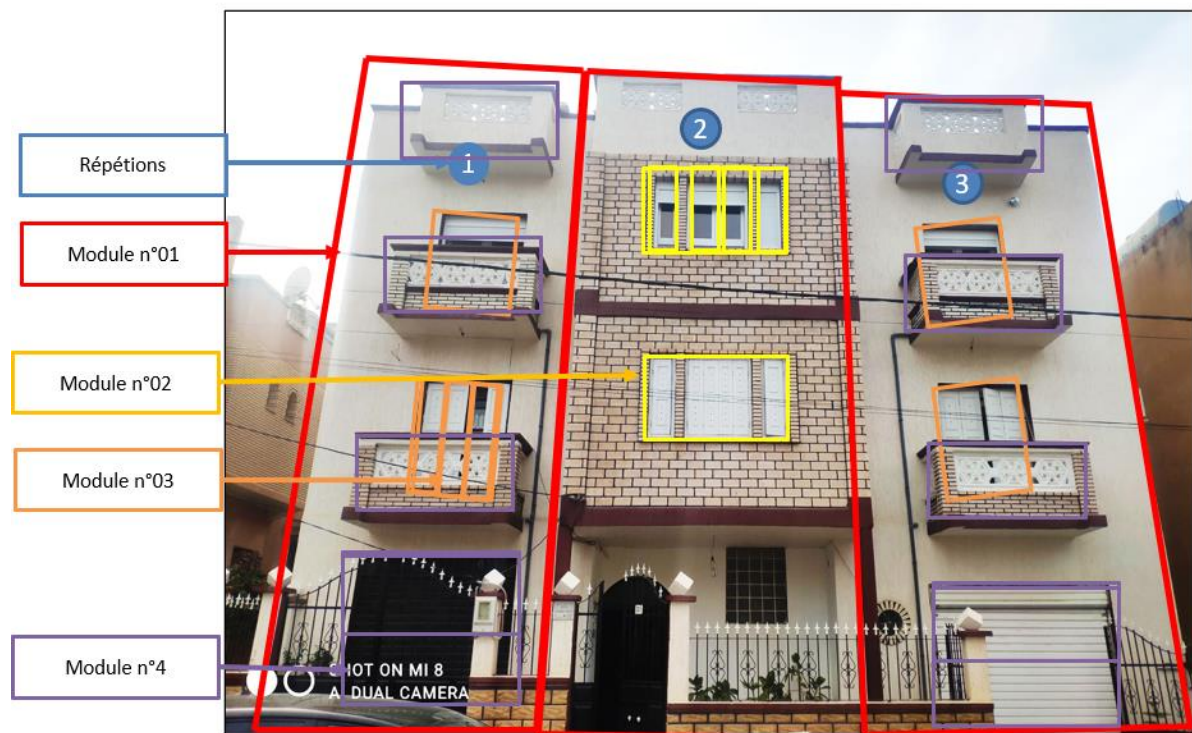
Etude de la façade ech 02 (source : auteur 2022)
